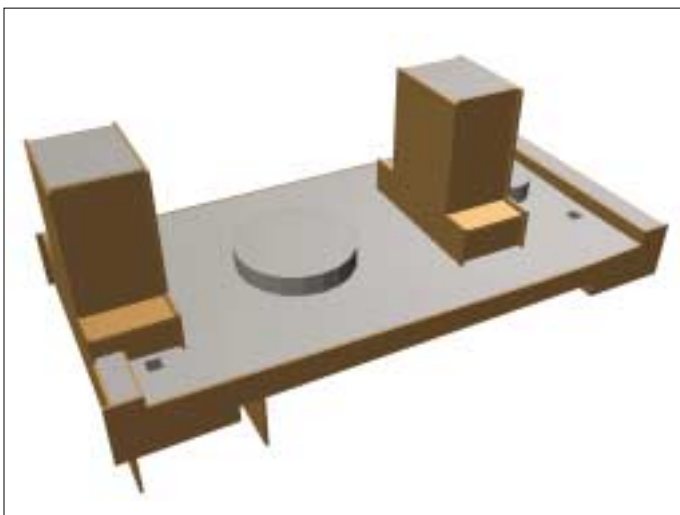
und 2. Plattenförmiger Träger für eine Papiermaschine. Allplan liefert einen automatisch eingeschalteten Betonkörper
